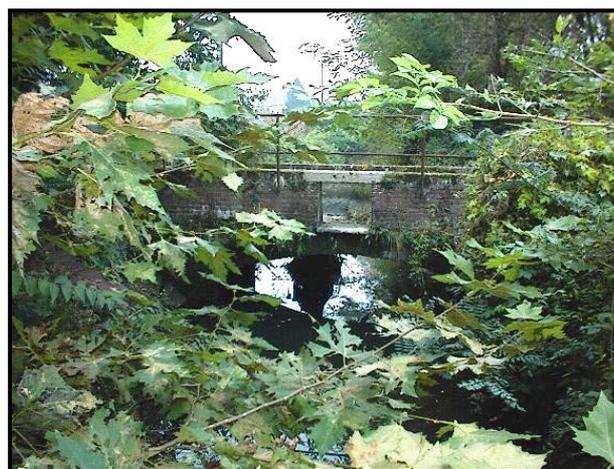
Vista da valle del ponte canale sulla R. Cornasso.
